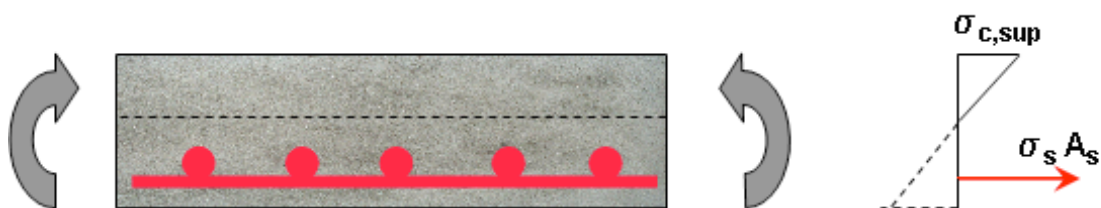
Schema di carico e di sforzo su una pavimentazione rinforzata con rete o barre di armatura.
